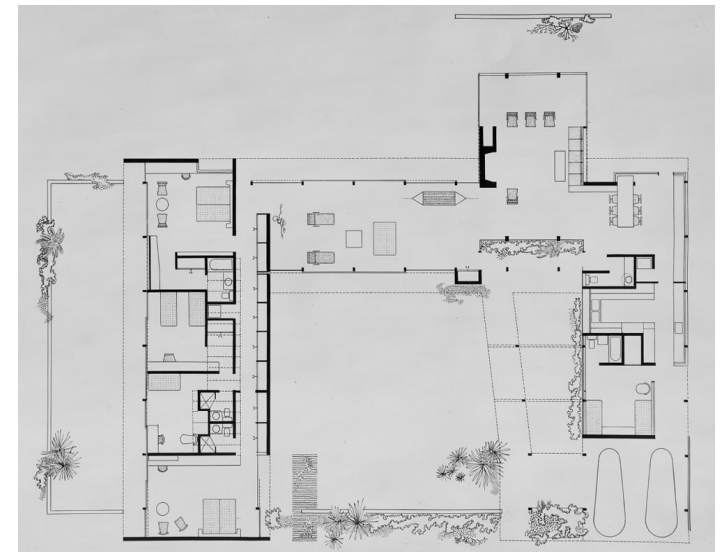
Planta de la Residencia Denman. Paul Rudolph Heritage Foundation
